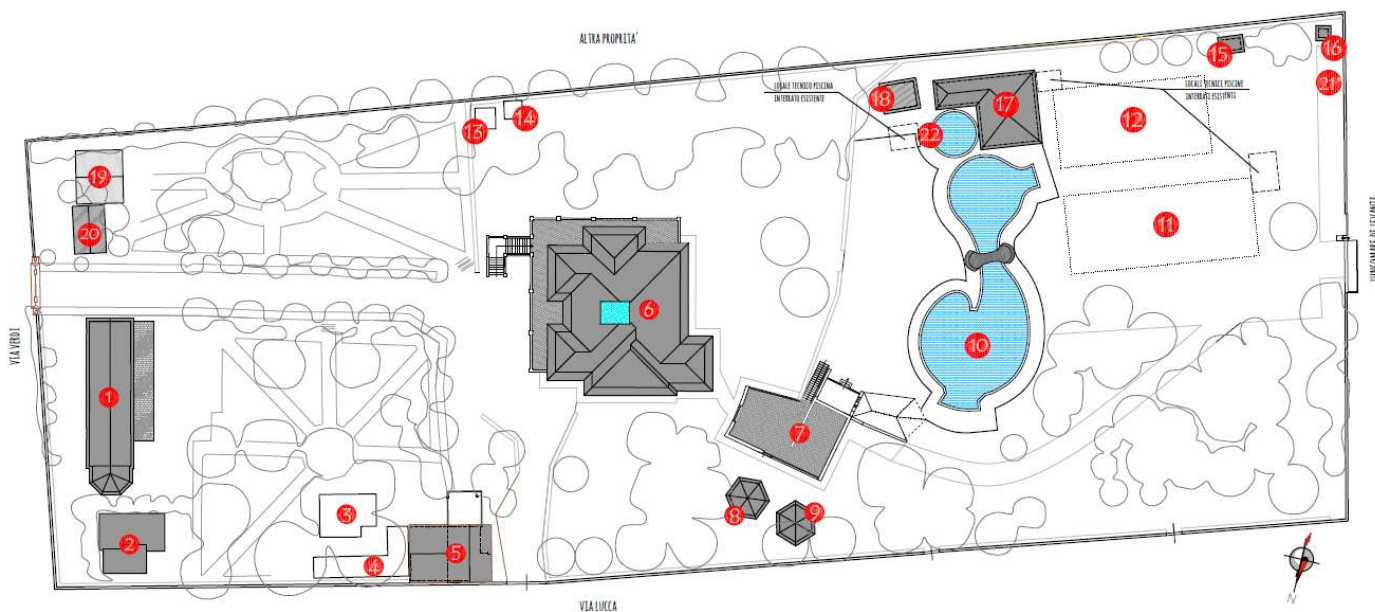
Planimetria contenente l'indicazione numerica dei fabbricati (stato attuale)
